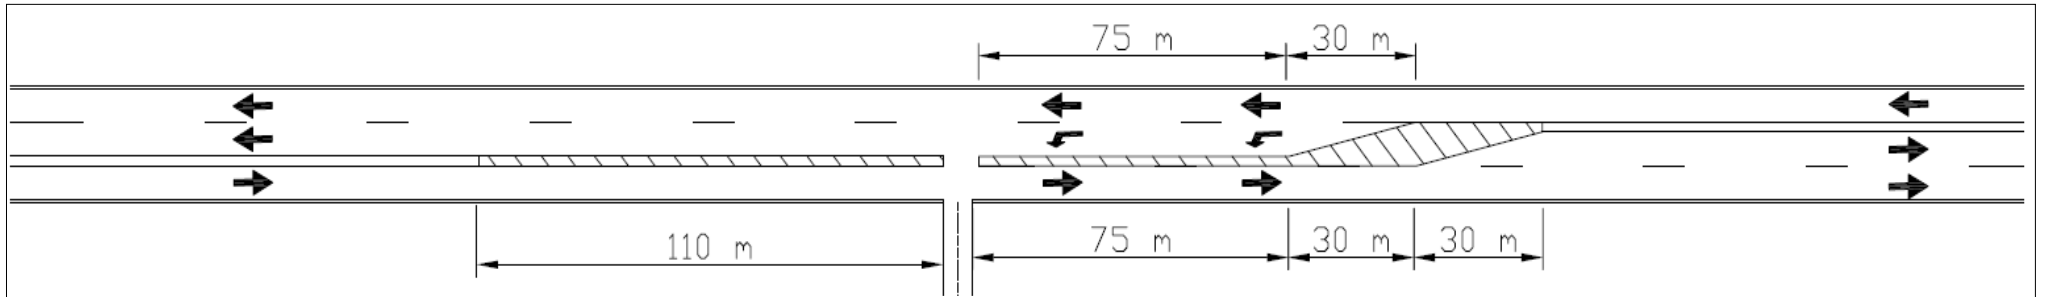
(intersecție cu zonă de alternanță de la 1 bandă pe sens la două benzi pe sens)
